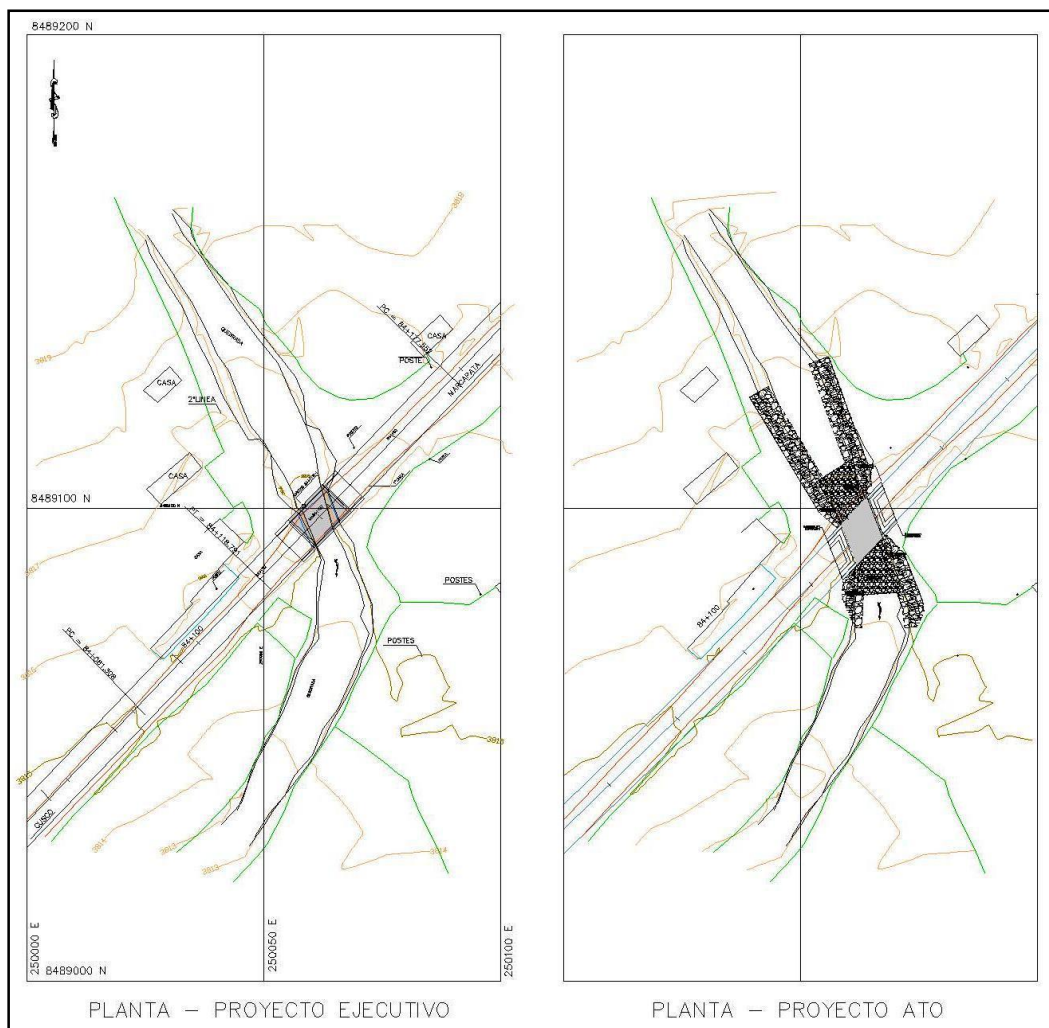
Obra de Arte Especial - Planta do Projeto Executivo e Projeto ATO.
